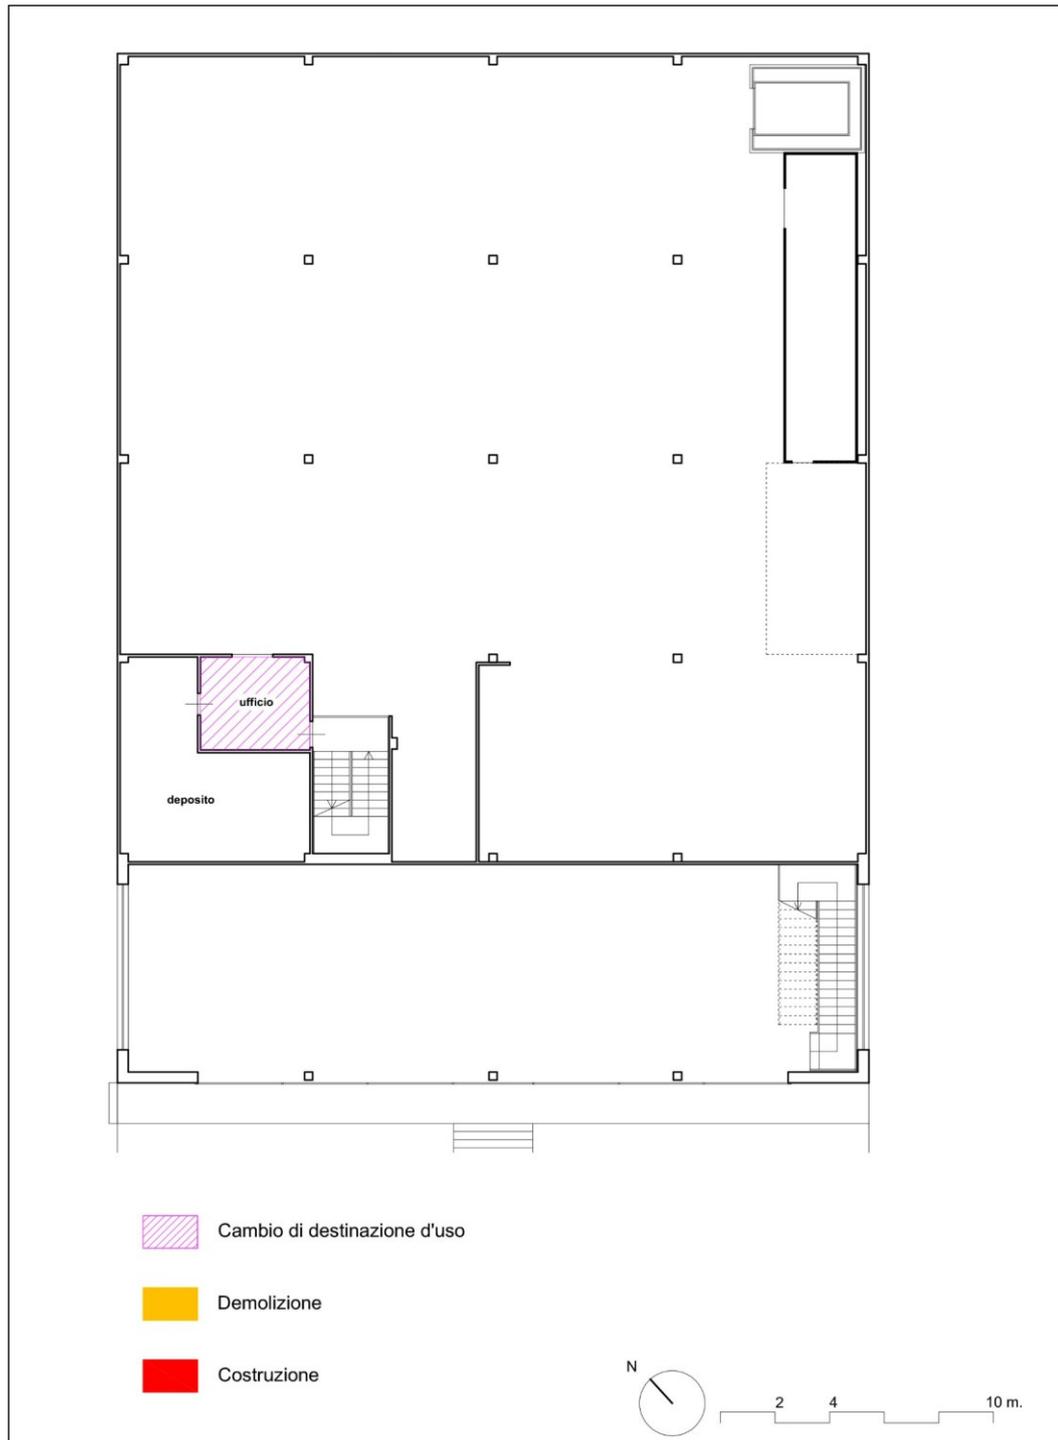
Confronto tra la planimetria catastale e lo stato di fatto. Piano ammezzato.
